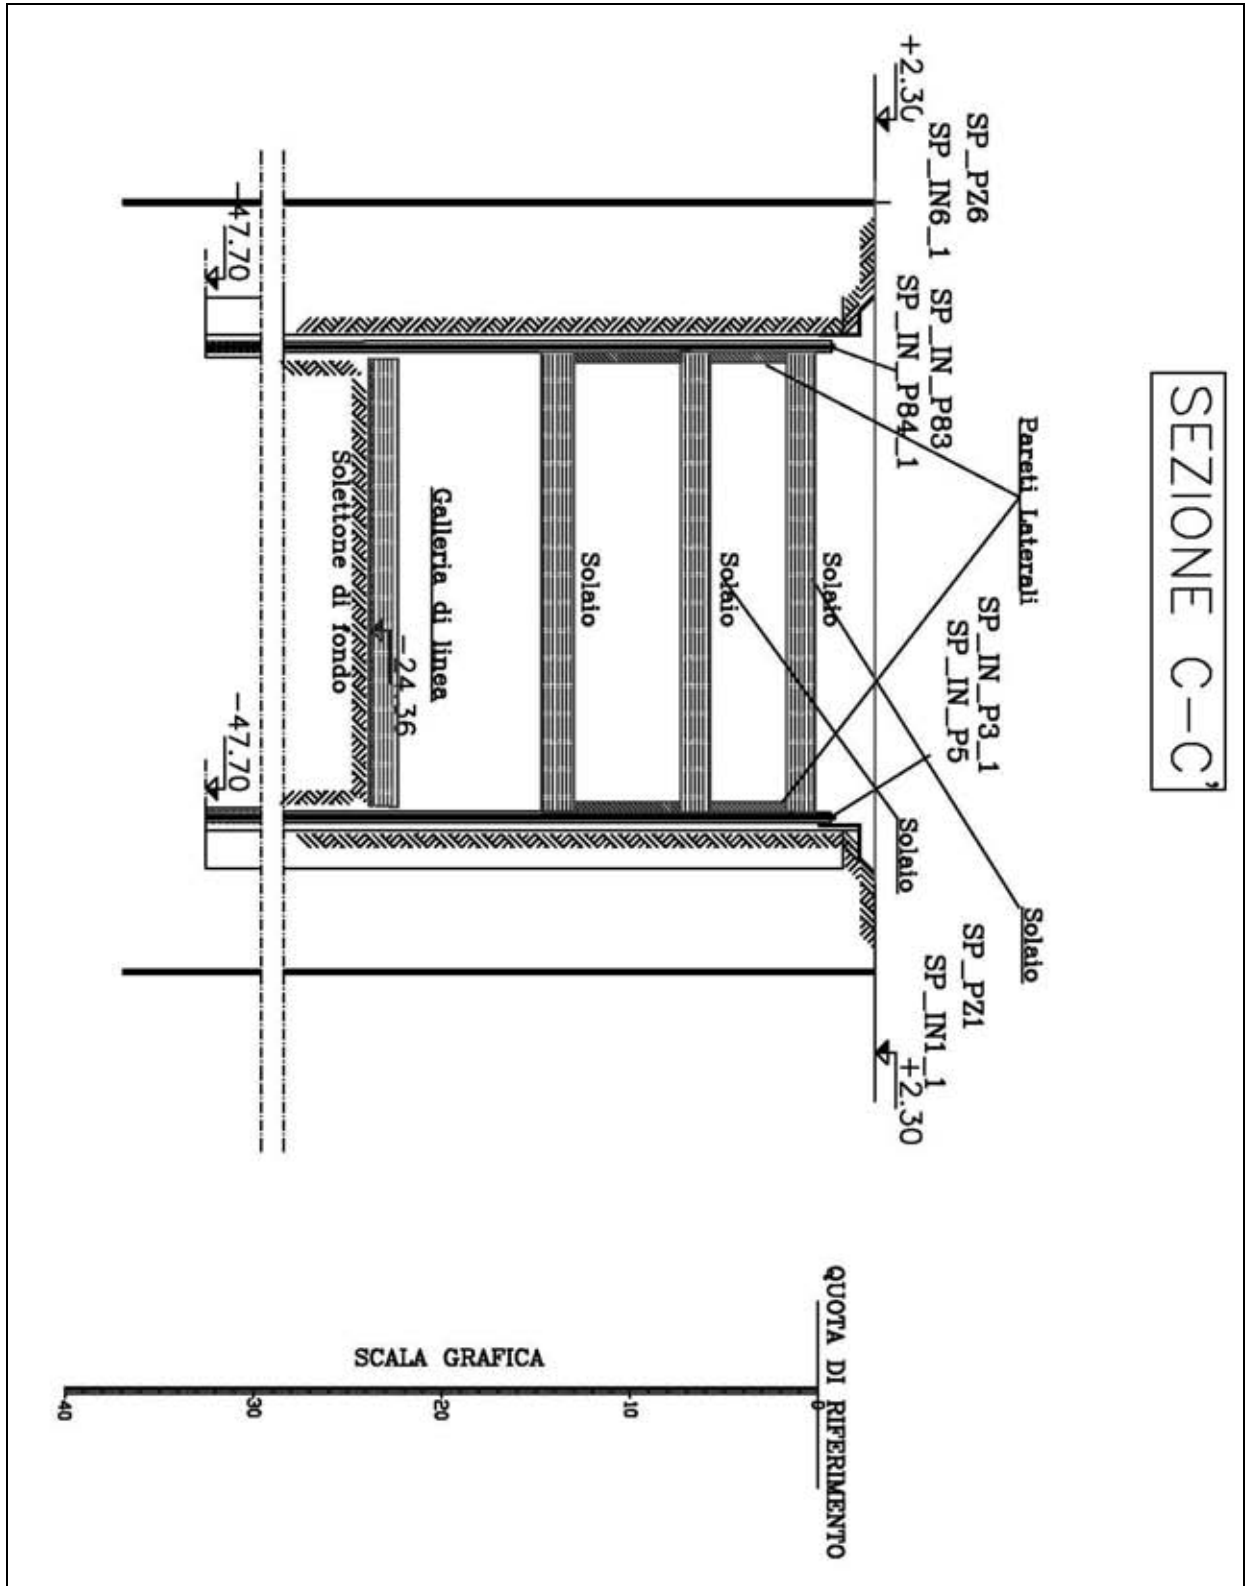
Sezione C-C' pozzo stazione, raffigurante la suddivisione in aree di lavoro.
